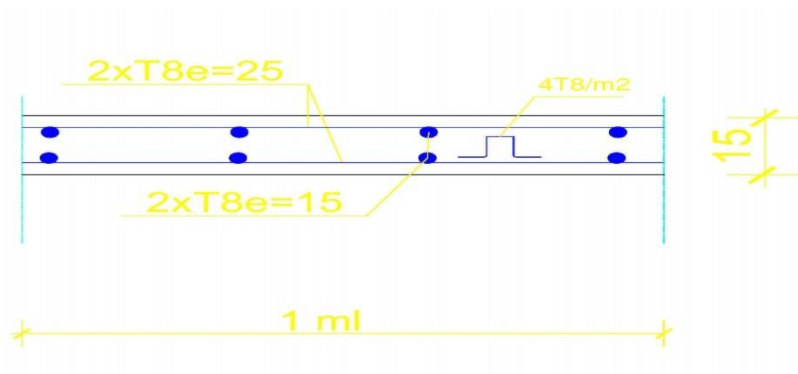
Schéma de ferrailage d'une bande de 1m de balcon
